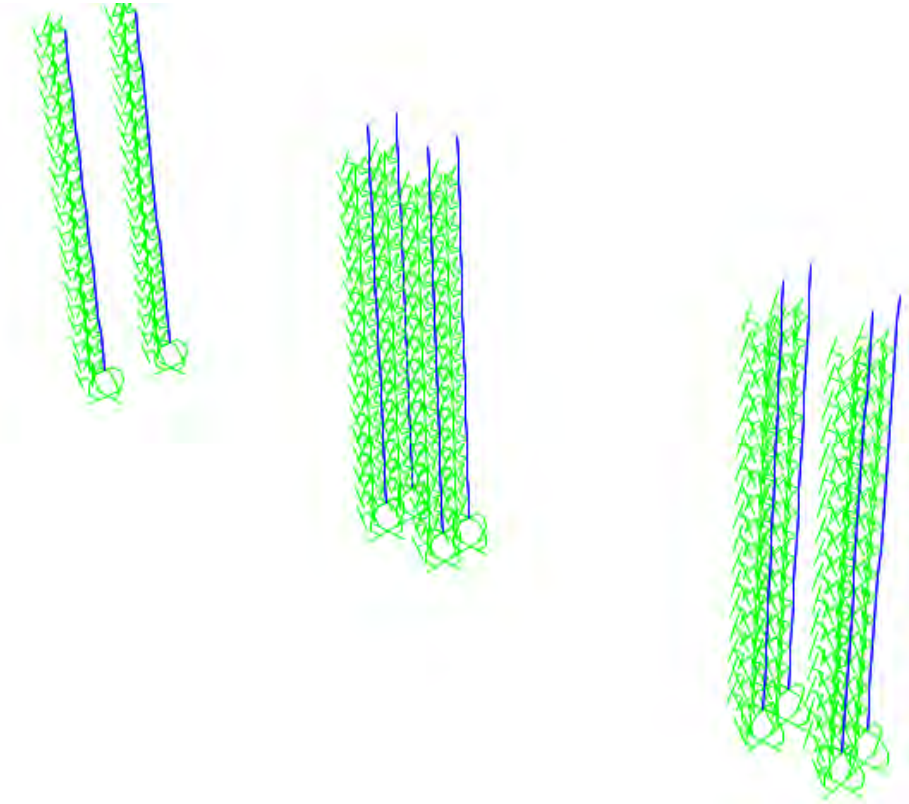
Geometría de los micropilotes de pilas y apoyo inferior.
